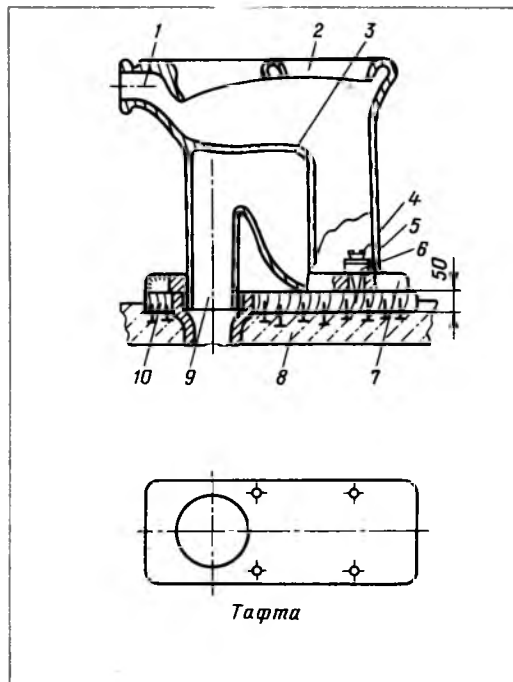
Установка на тафте унитаза с прямым выпуском: 1 — горловина; 2 — водораспределительный желоб; 3 — тарельчатая чаша; 4 — шуруп; 5 — шайба металлическая; 6 — кожа или резина; 7 — прилив; 8 — цемент; 9 — выпуск; 10 — тафта
